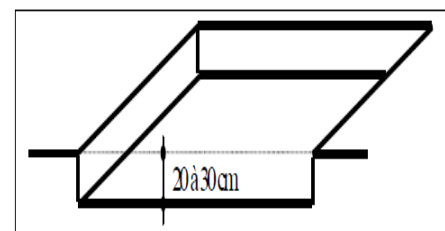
Fouilles en pleine masse ou en excavation : Il englobe des travaux d'envergure aussi bien en surface qu'en hauteur.
